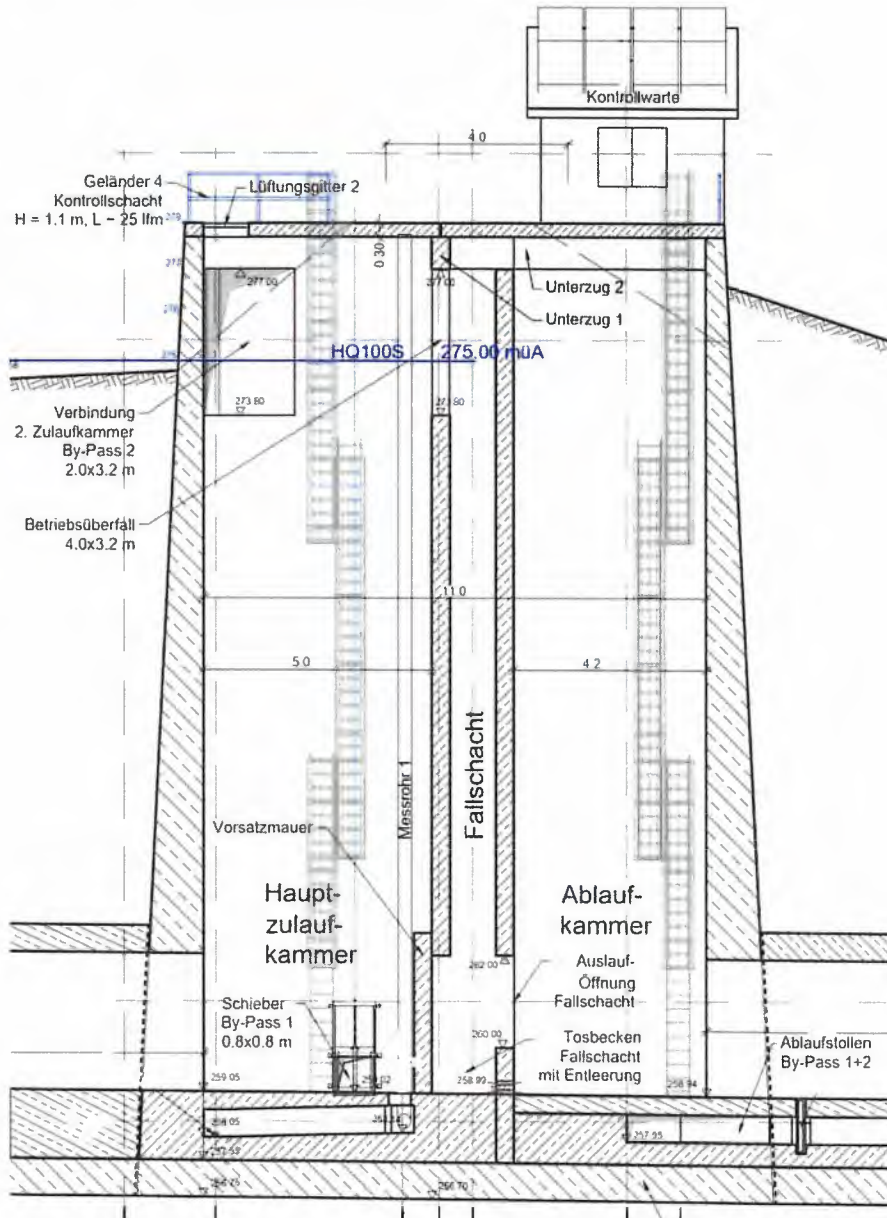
Längsschnitt durch den Kontrollschacht (aus Beilage 12.5.2)
